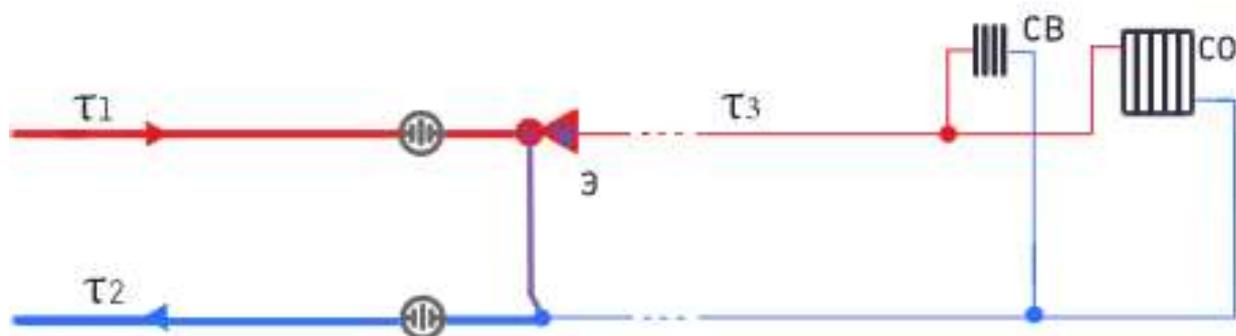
ЦТП с элеваторным присоединением СО и СВ
